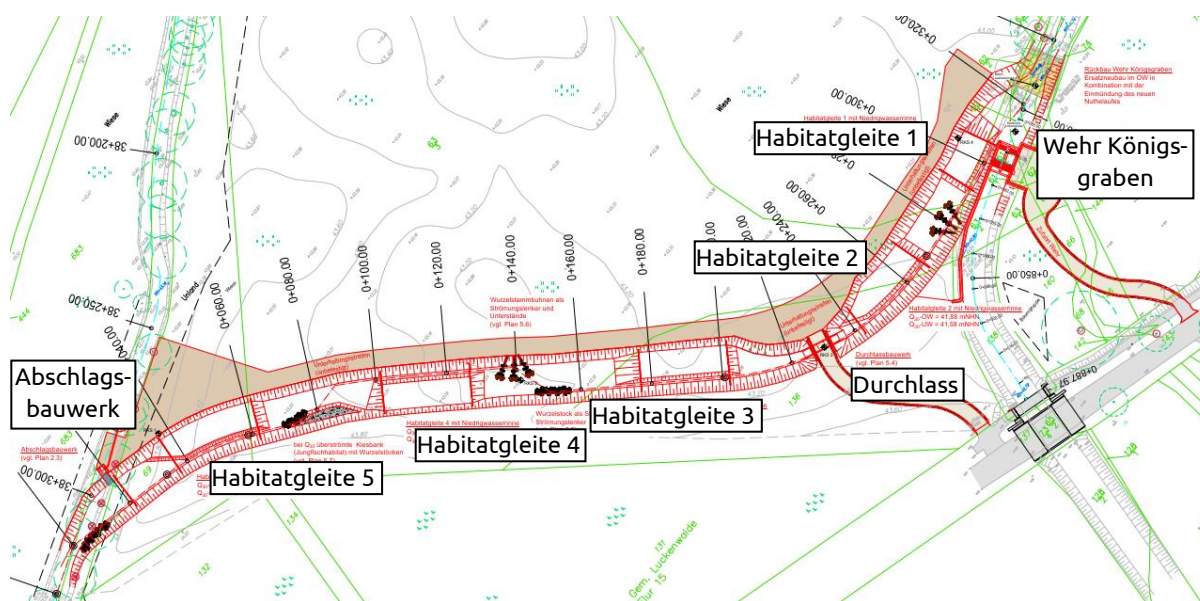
Lageplan der Habitatgleitenstaffel mit Ruhezonen (Auszug) (/P1/)
